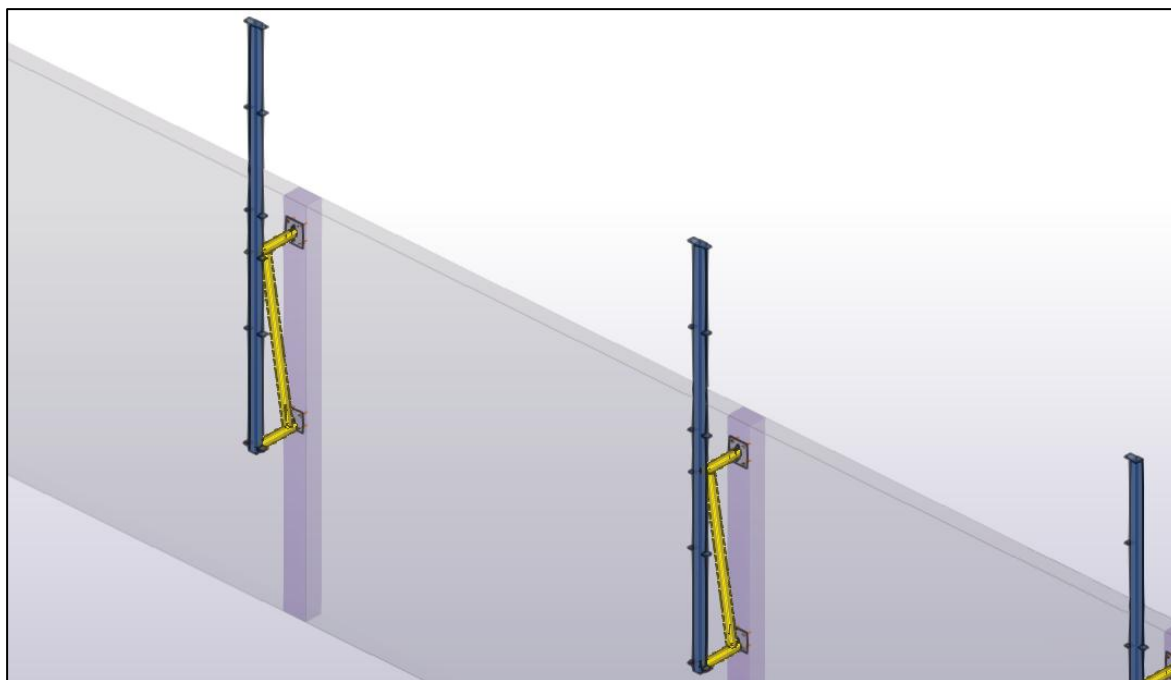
Estrutura metálica fixada nos pilares de betão armado, com identificação do perfil SHS80x5 (a amarelo) e do perfil SHS100x5 (a azul) (Autor/Tekla Structures).
